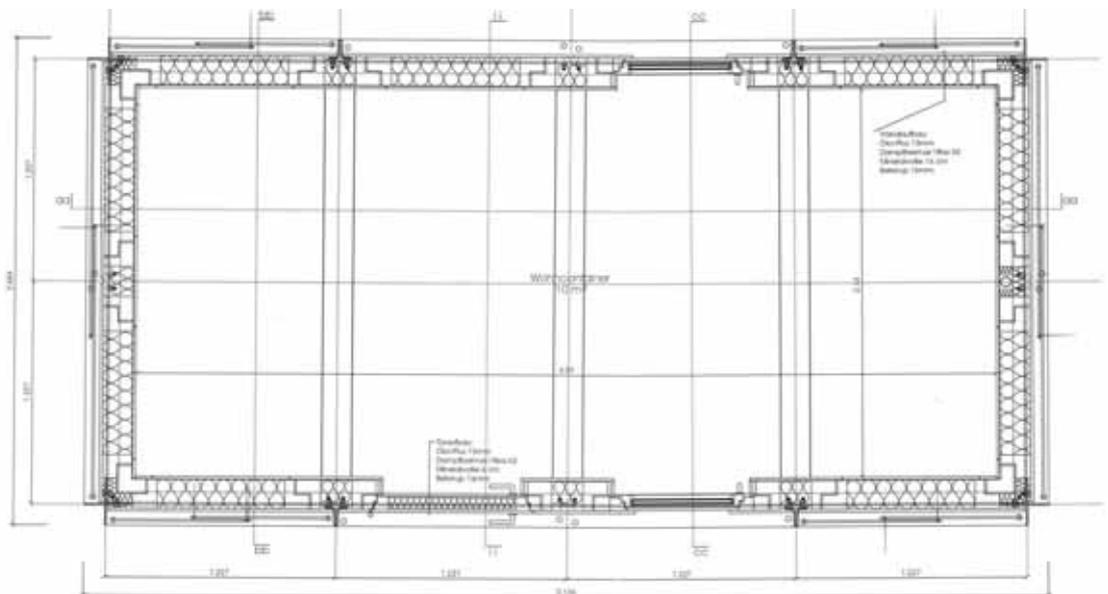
Grundriss Vinzidorf-Containermodul
